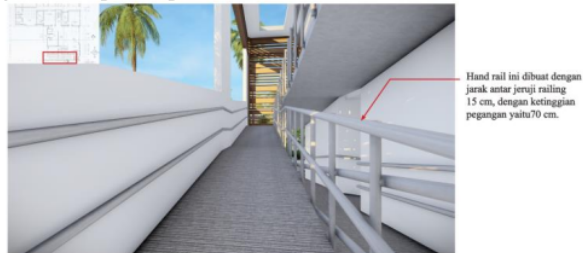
Desain Ramp untuk Disabilitas Tuna Daksa
